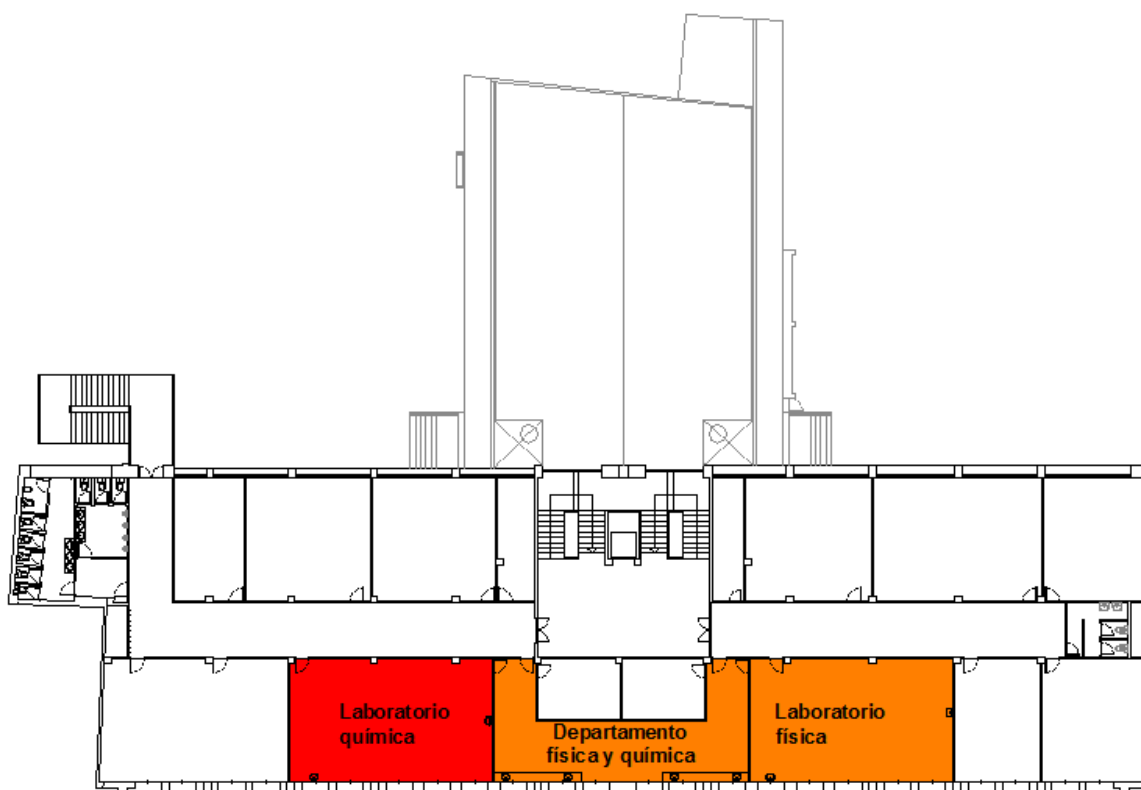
Locales de riesgo planta tercera. Fuente: elaboración propia.
